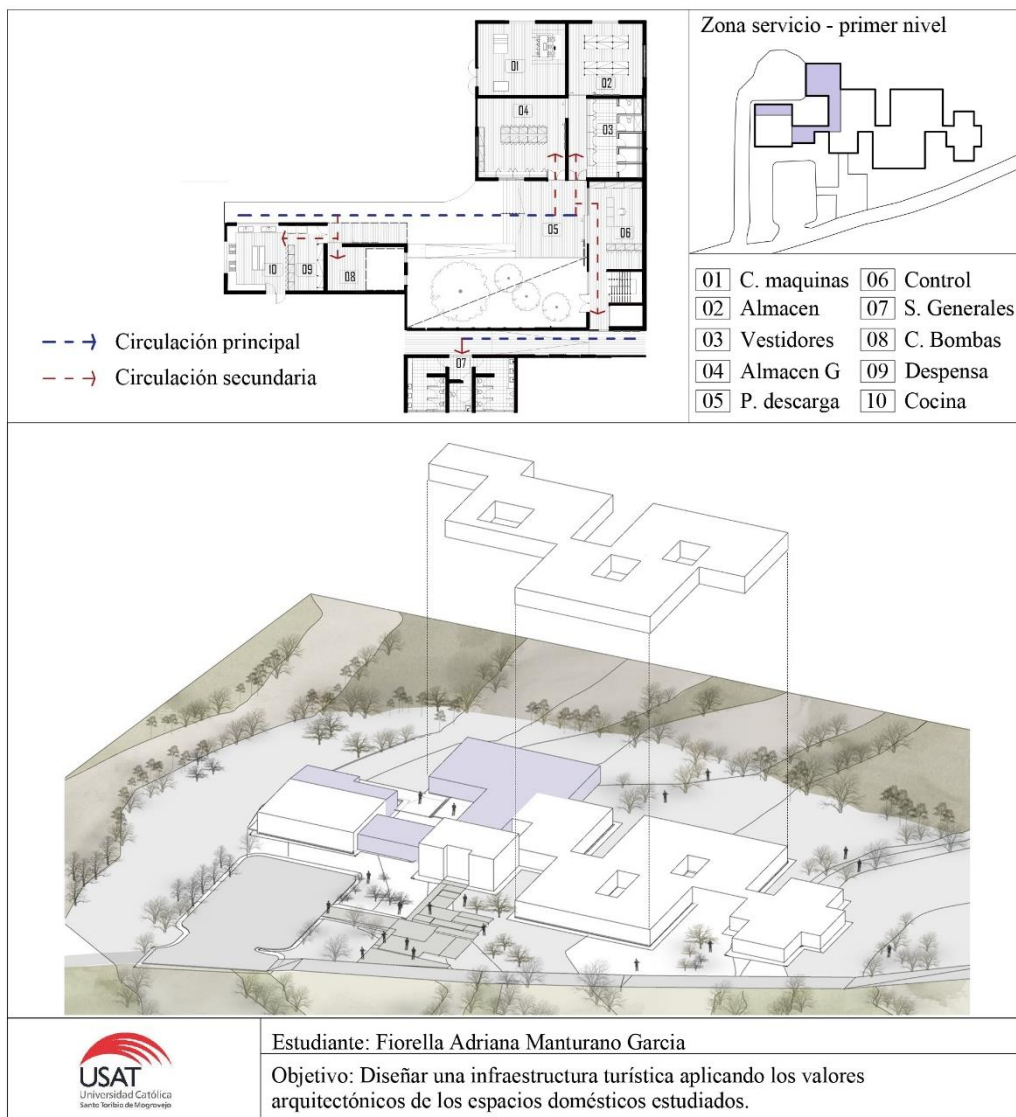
Zona Servicio Plano / Axonometría(Primer Nivel) . Fuente:Elaboración Propia
